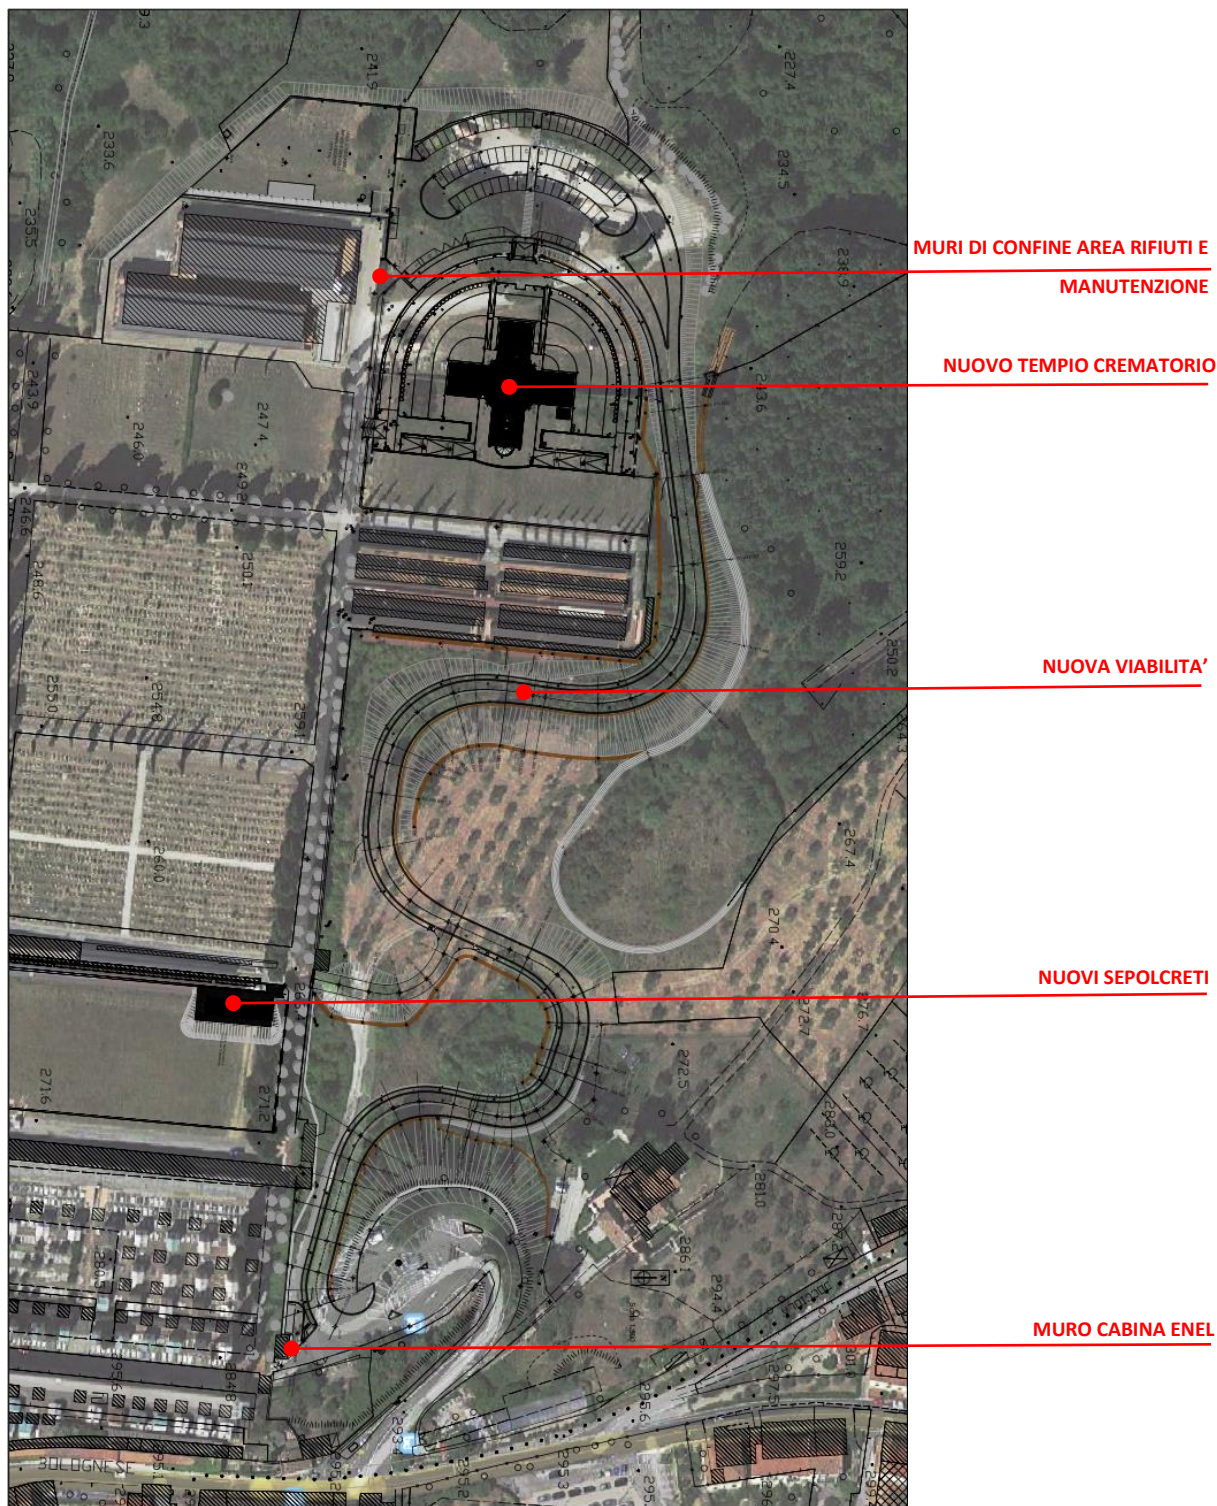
INQUADRAMENTO PLANIMETRICO DEGLI INTERVENTI
